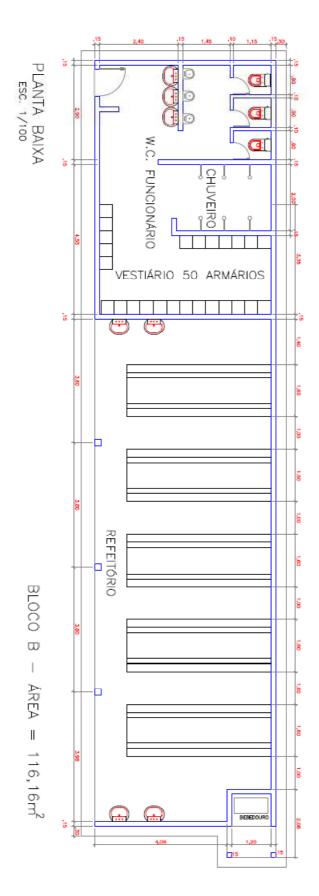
Planta baixa do segundo bloco do barração de 50 pessoas.
